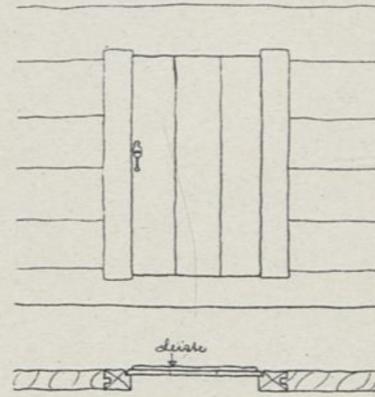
einfache Brettler mit Posten in durchgehendem angedrehtem Wandbalken als Stütz.
